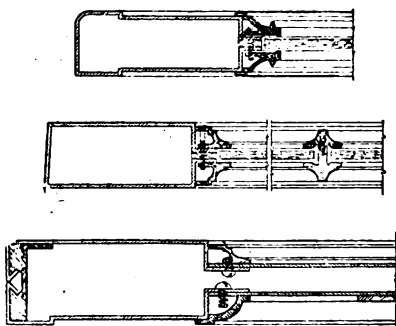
/5. Profile geschweißter Bronzetüren; die beiden oberen mit Glasfüllung, die untere mit Metallblechfüllung.
